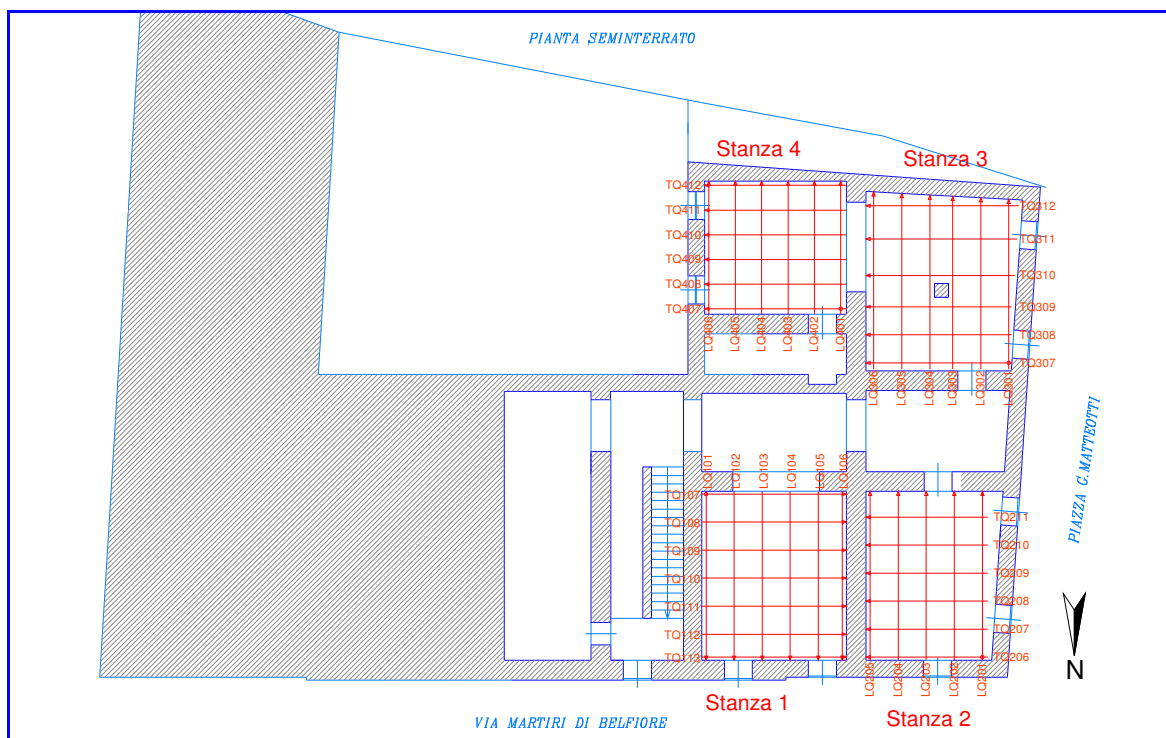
Planimetria del piano interrato con le porzioni indagate
